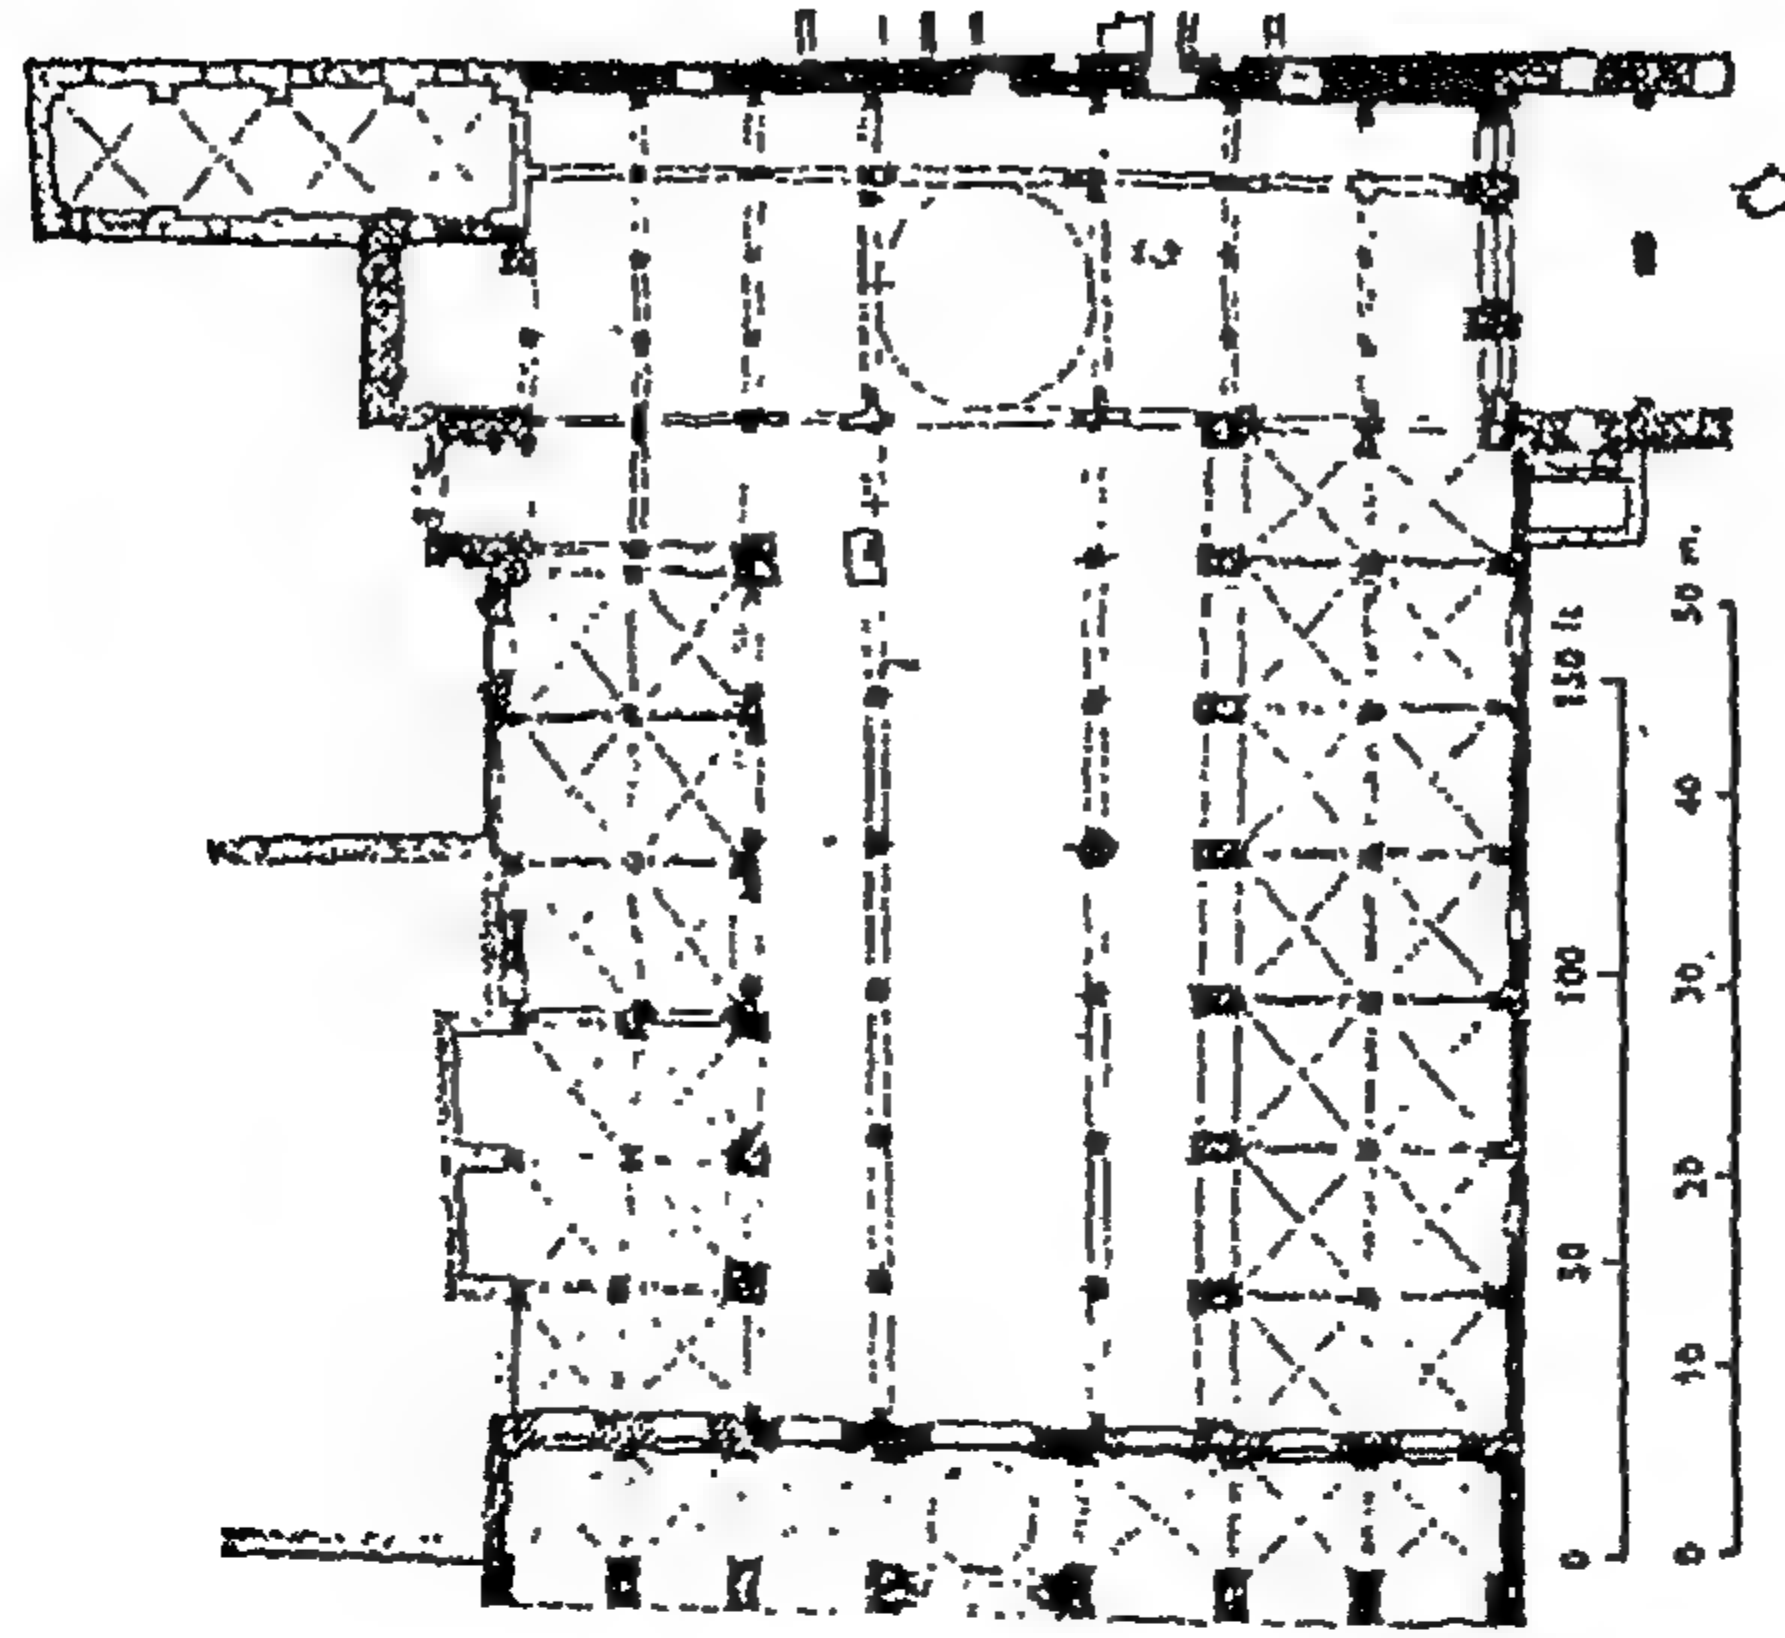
مسقط أفقي للمسجد الملحق بقصر الحير الشرقي . (عن : كريزول) .
